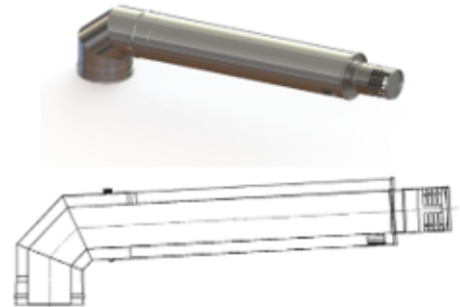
Terminaux chapeaux AR PLA (conduit PLA)
